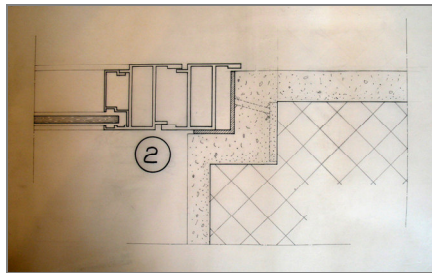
particolare serramento (fonte CSAC – stralcio tav. 31, archivio n. 400-1)
